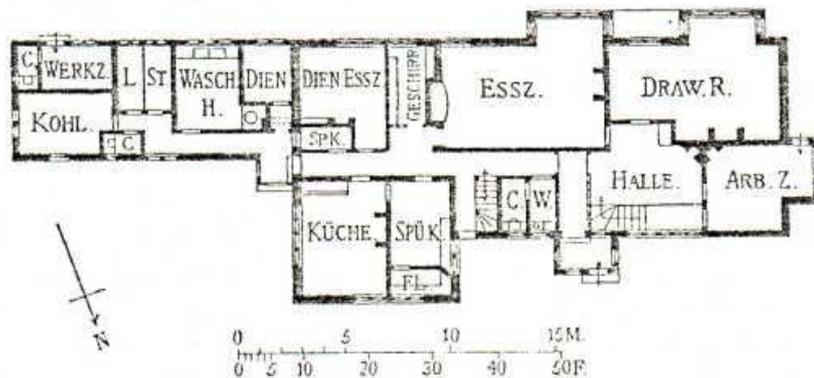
Haus Belgaum in Woking, Surrey. Erdgeschoß. Erbaut von Walter Cave. 1:400.
